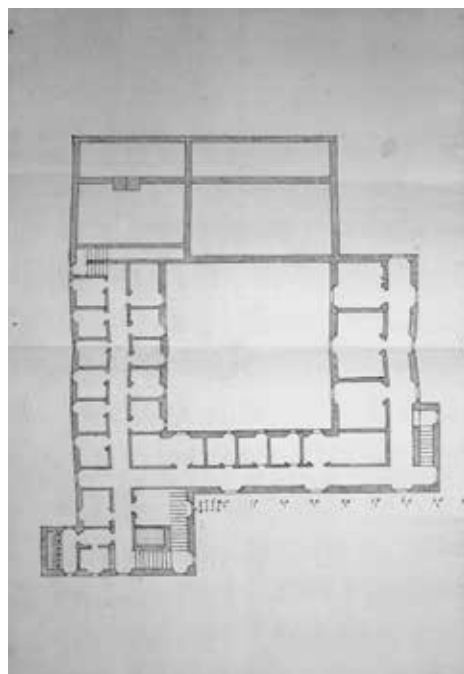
L'Aquila, Archivio Storico dei Cappuccini d'Abruzzo, Conventi chiusi o soppressi, busta Cermignano. Pianta piano superiore, 1672
